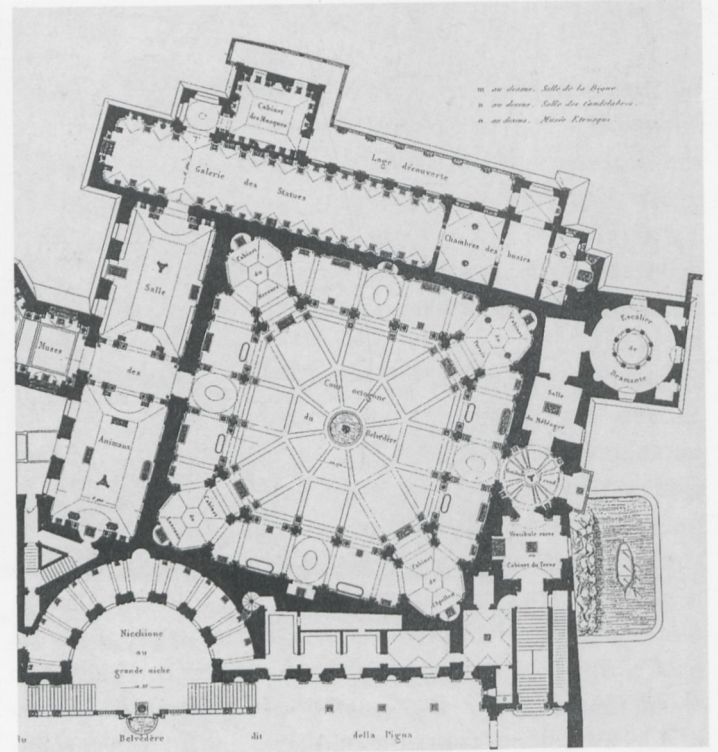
Paul Letarouilly, Pianta del pianterreno del Belvedere, dettaglio (Le Vatican, tav. 245)
